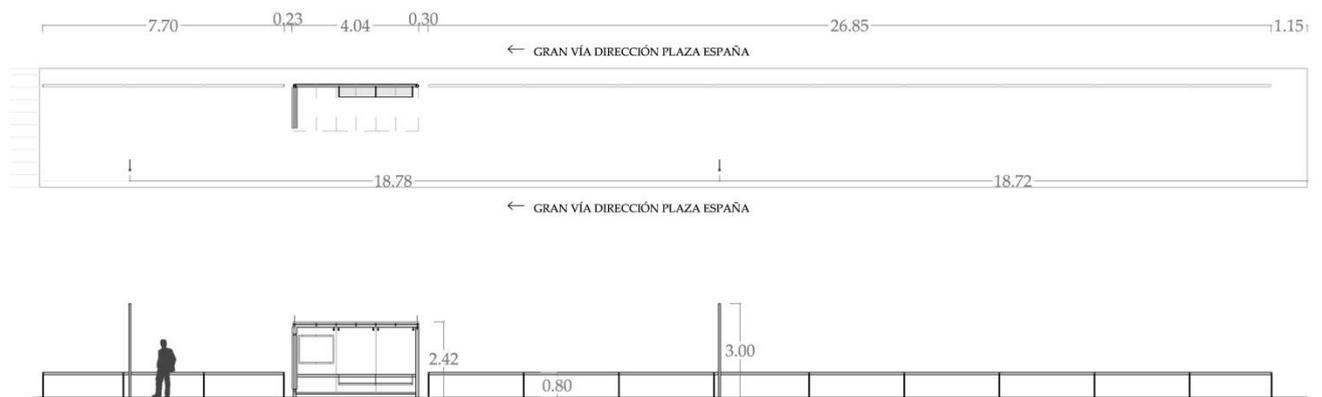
Planta y alzado parada 1310 Gran Vía Santa Dorotea. Dibujos de la autora.
